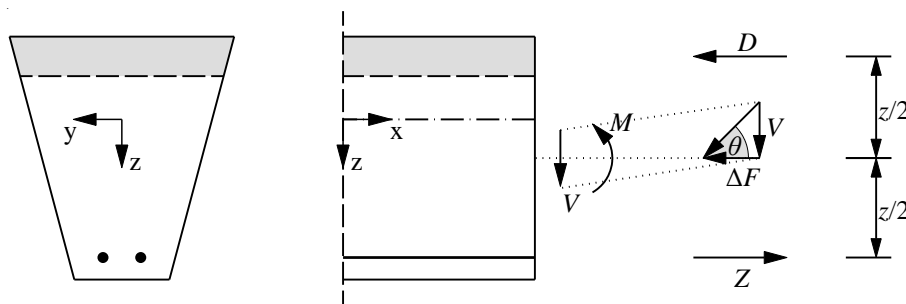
Zusätzliche Beanspruchung des Druck- und Zuggurtes infolge schräger Betondruckstreben infolge Schubrissbildung (in Anlehnung an Graubner (1989))
